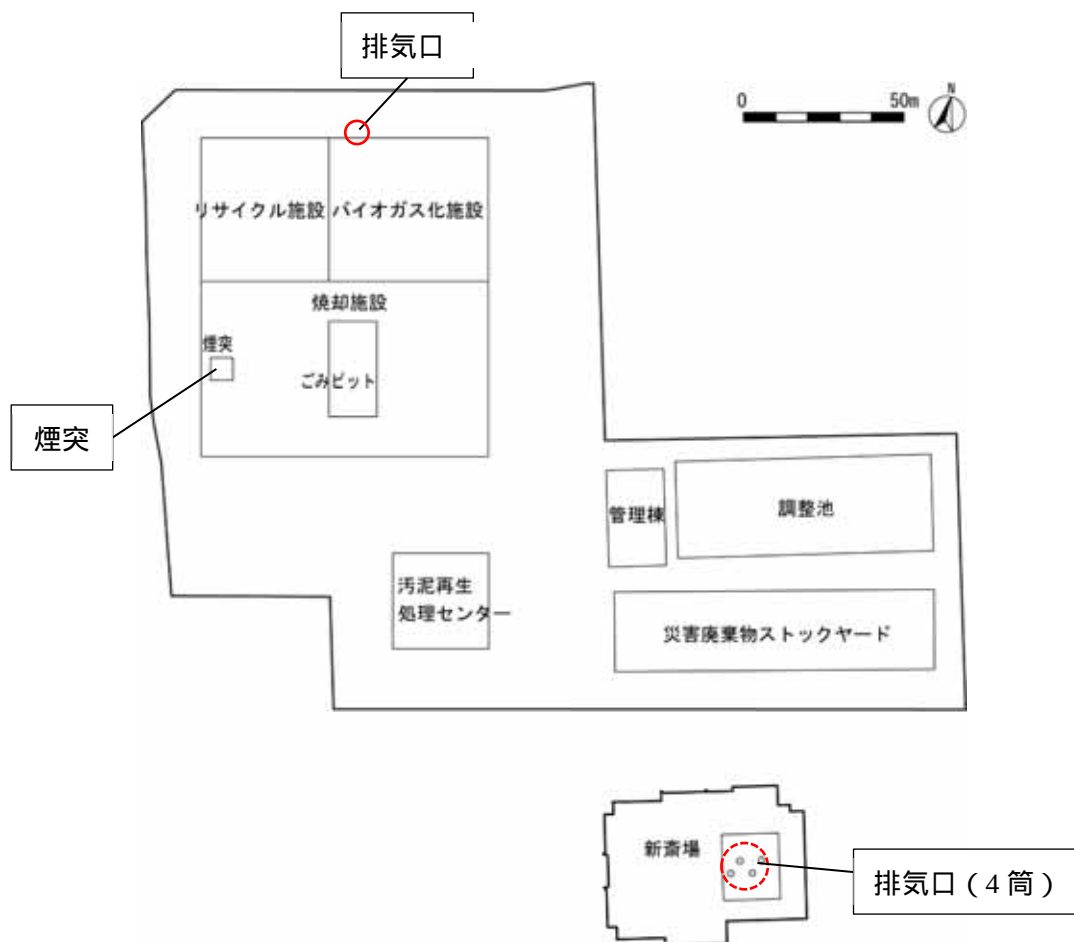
予測に用いた煙突および排気口位置（平面図）
